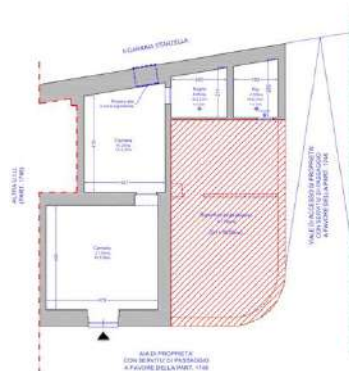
Planimetria dello Stato di fatto con indicazione dell'abuso (cfr. All. 9b)
